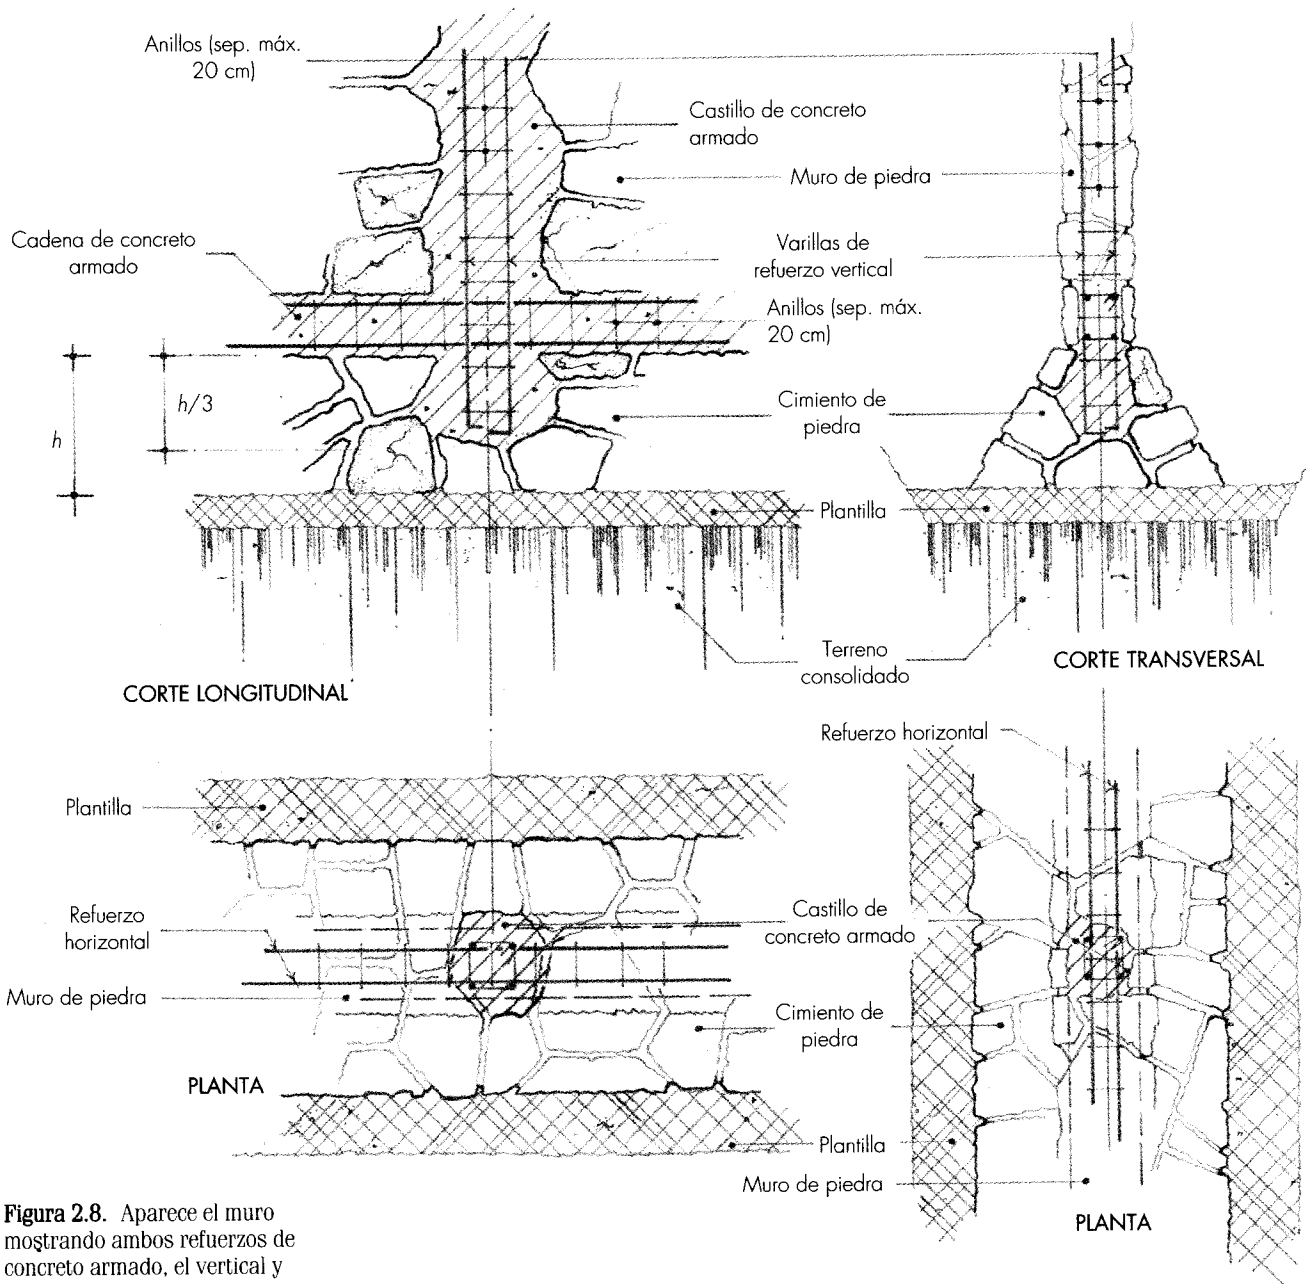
Aparece el muro mostrando ambos refuerzos de concreto armado, el vertical y el horizontal.
